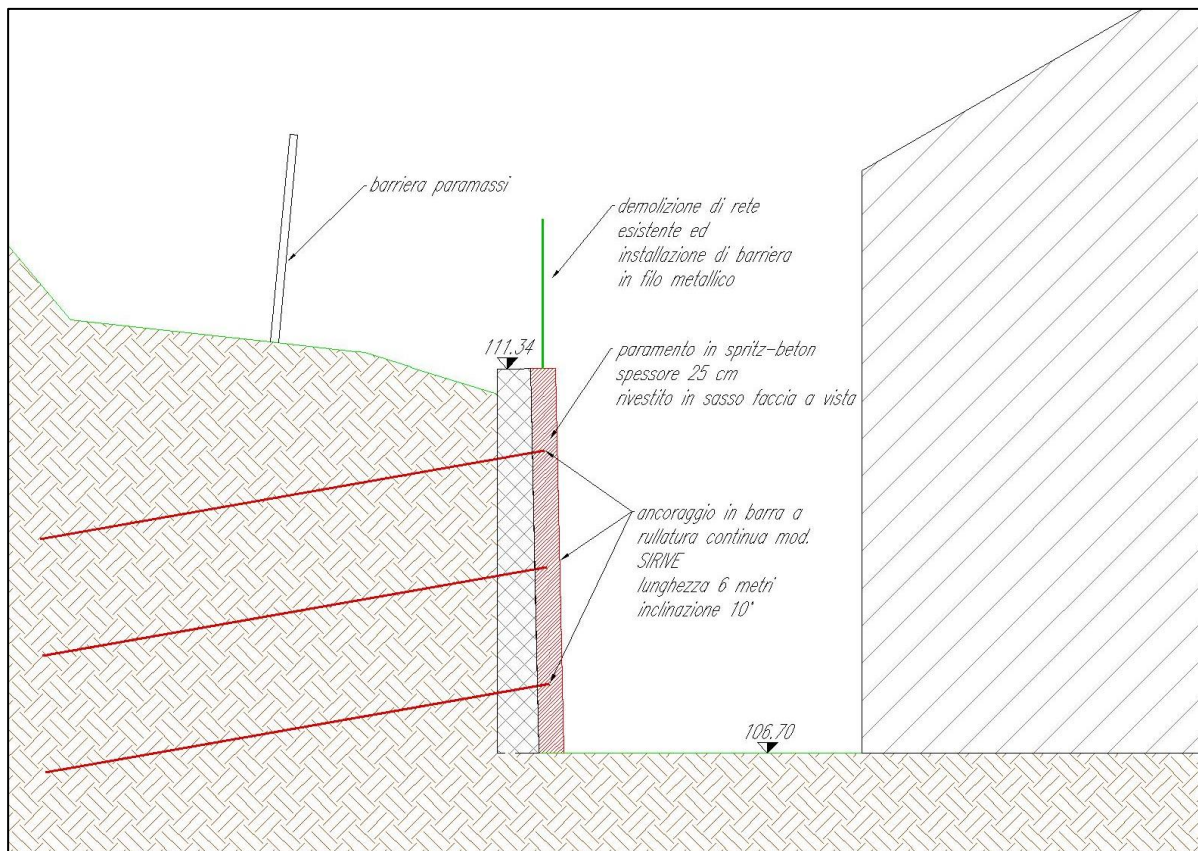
Sezione tipo dell'intervento in via Beato Lorenzino
